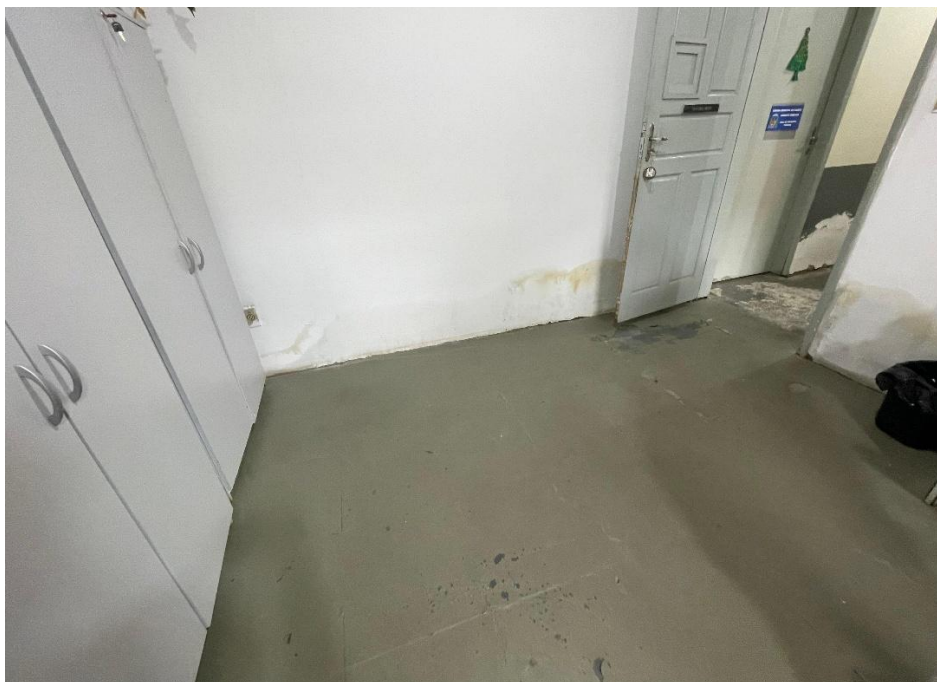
06/01/2026 – Parte interna de sala do galpão. Degradação do piso. Mancha da água na parede.
